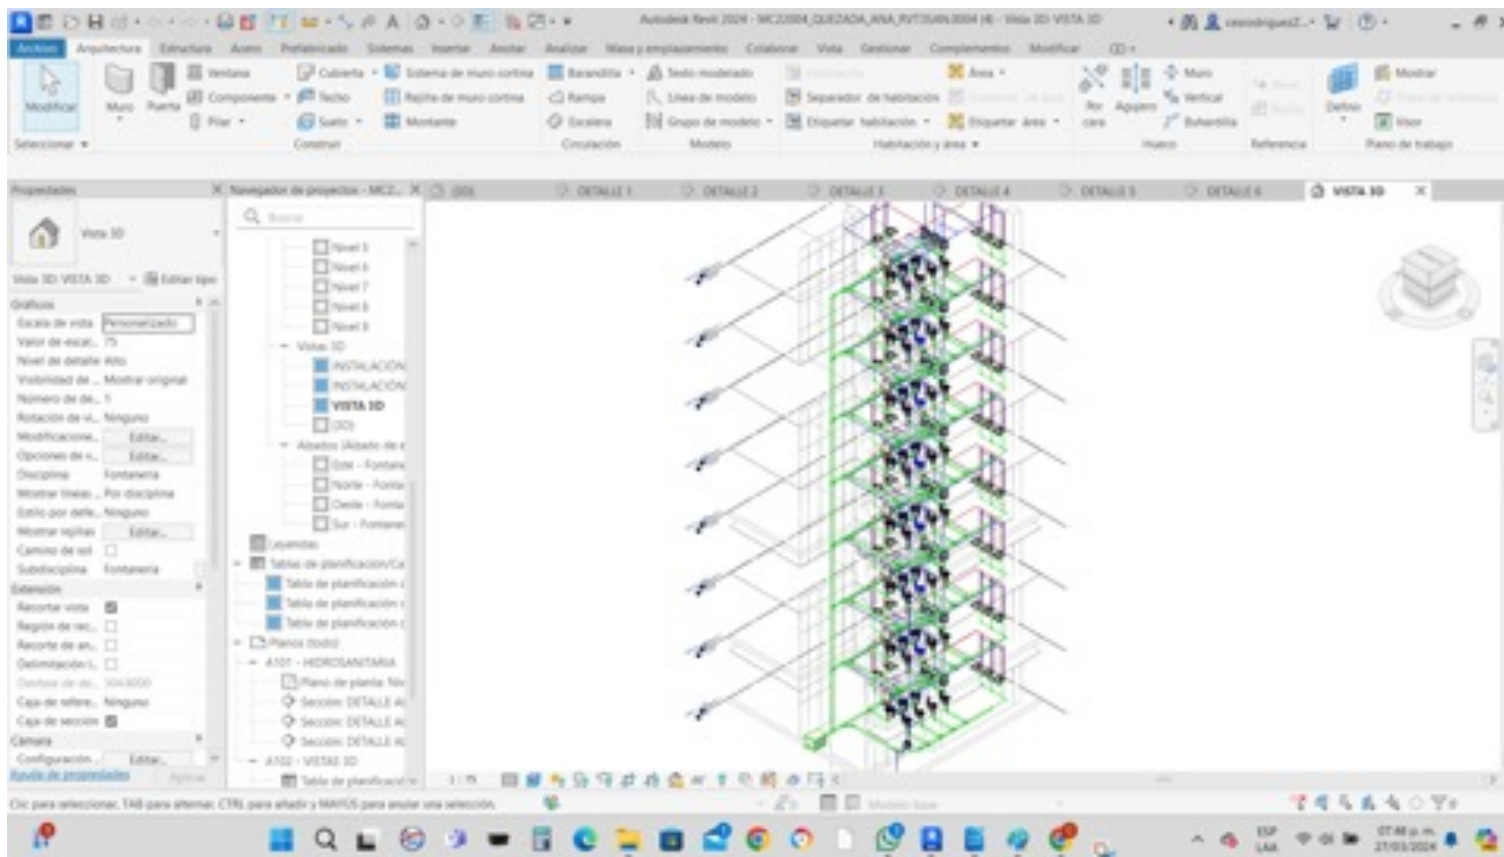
Vista 3D general del proyecto hidrosanitario de la alumna Ana Belén Quezada López de la materia Revit III de la maestría en construcción del ITC
